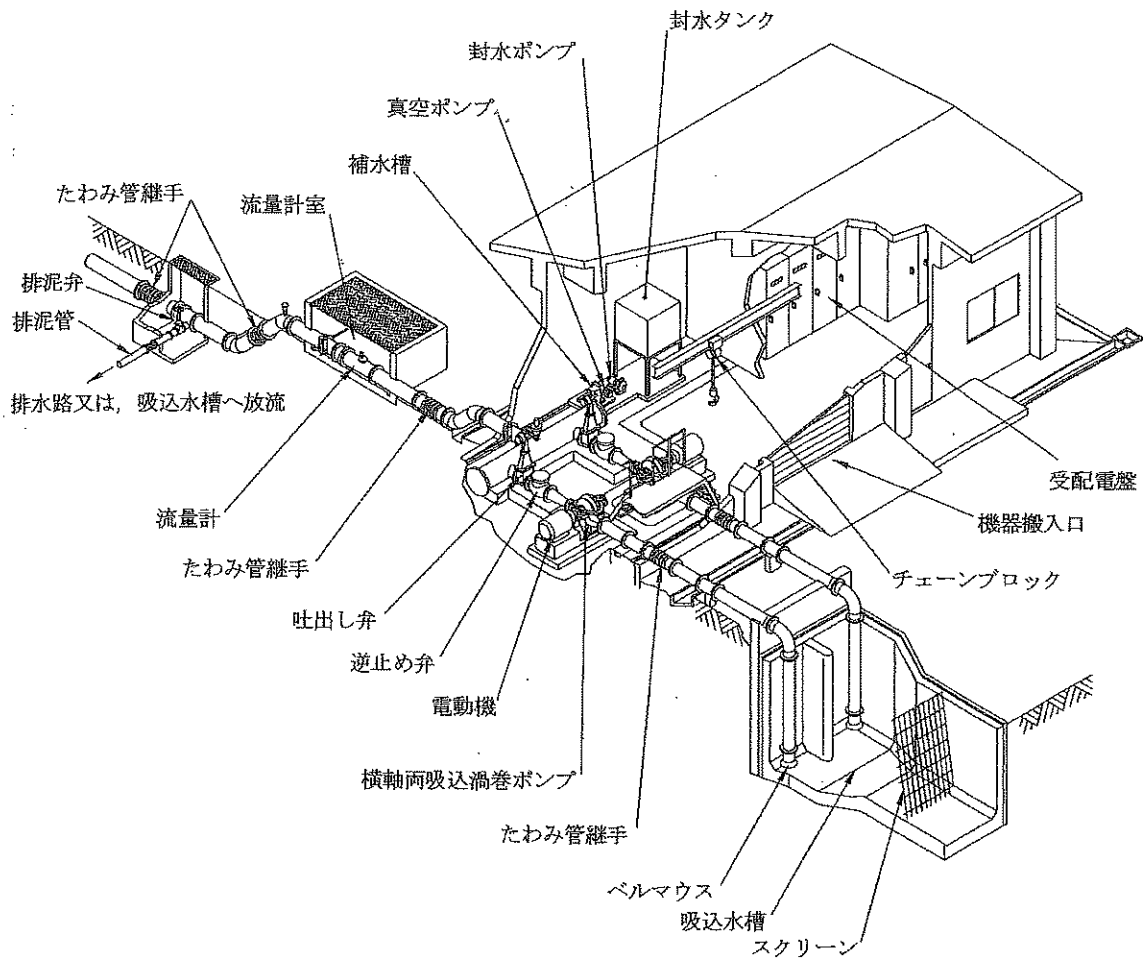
ポンプ場（用水・横軸両吸込渦巻ポンプ）の施設（例）
